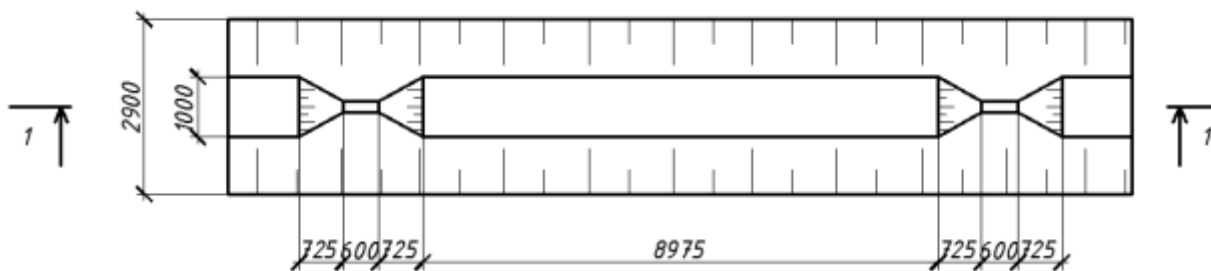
Схема засыпки трубопровода перед испытанием
